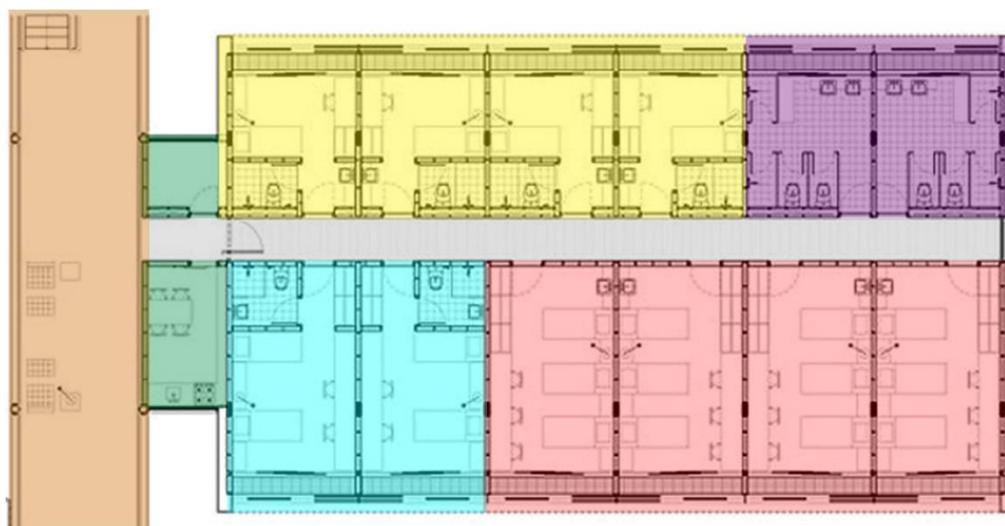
Setorização da Planta Baixa Tipo do Primeiro e Segundo Pavimento.
